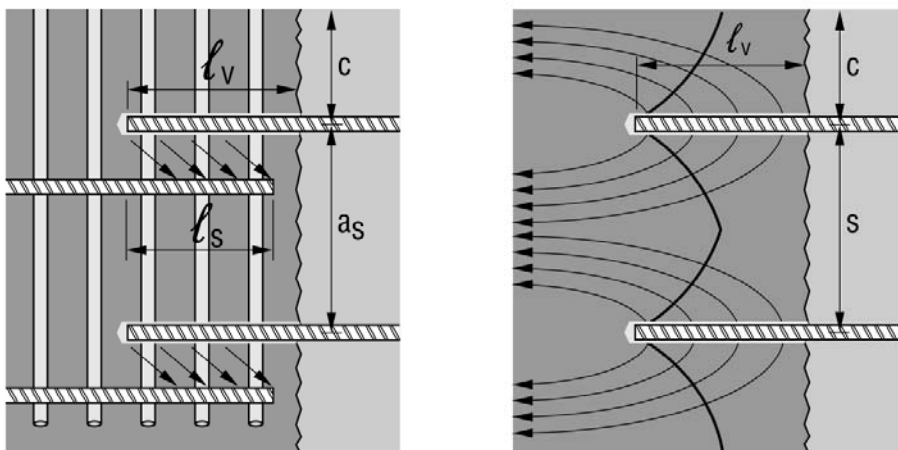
Unterschied zwischen eingemörtelten Bewehrungsstäben mit und ohne Anschlussbewehrung
